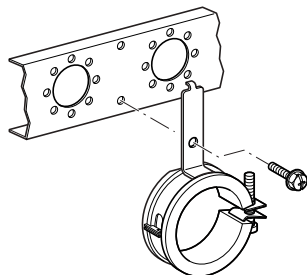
Montagem da braçadeira de tubo de drenagem Geberit para placas de montagem
